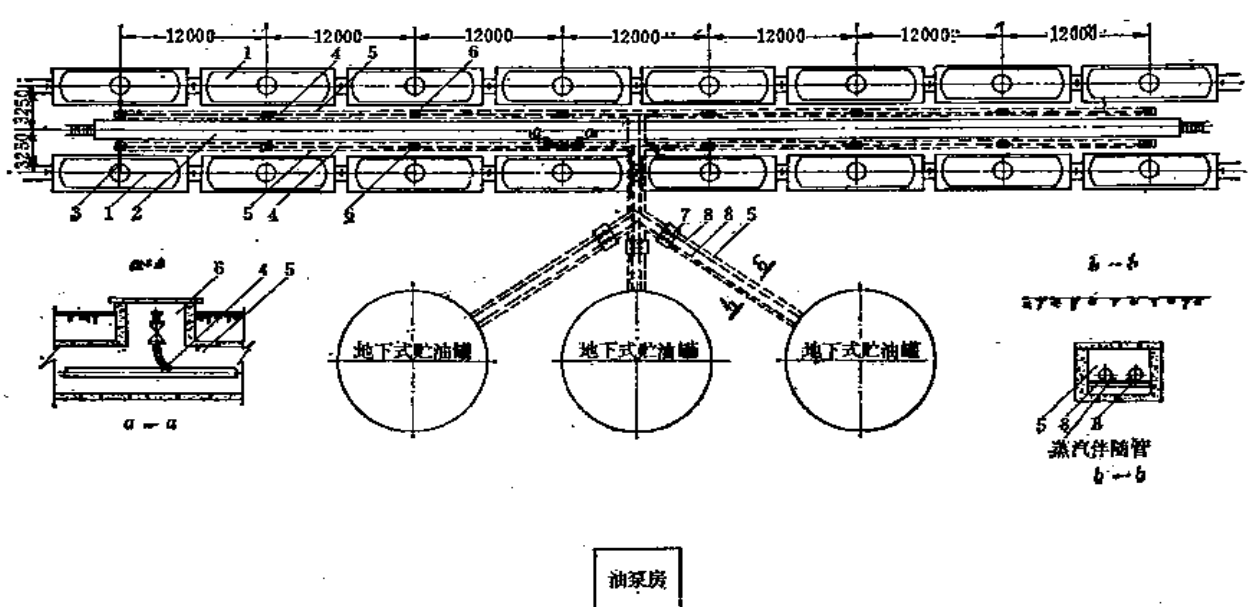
长管下卸(封闭式)设施(双侧)平面布置图
